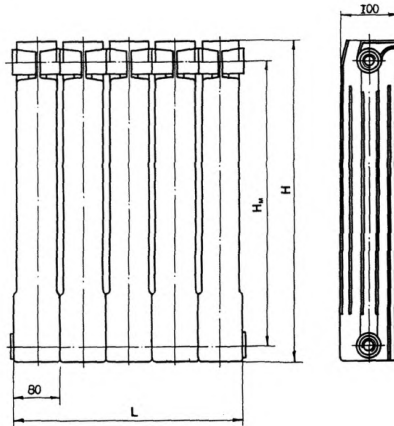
Общий вид (а) и габаритные размеры (б) радиатора «Сантехпром БМ»
